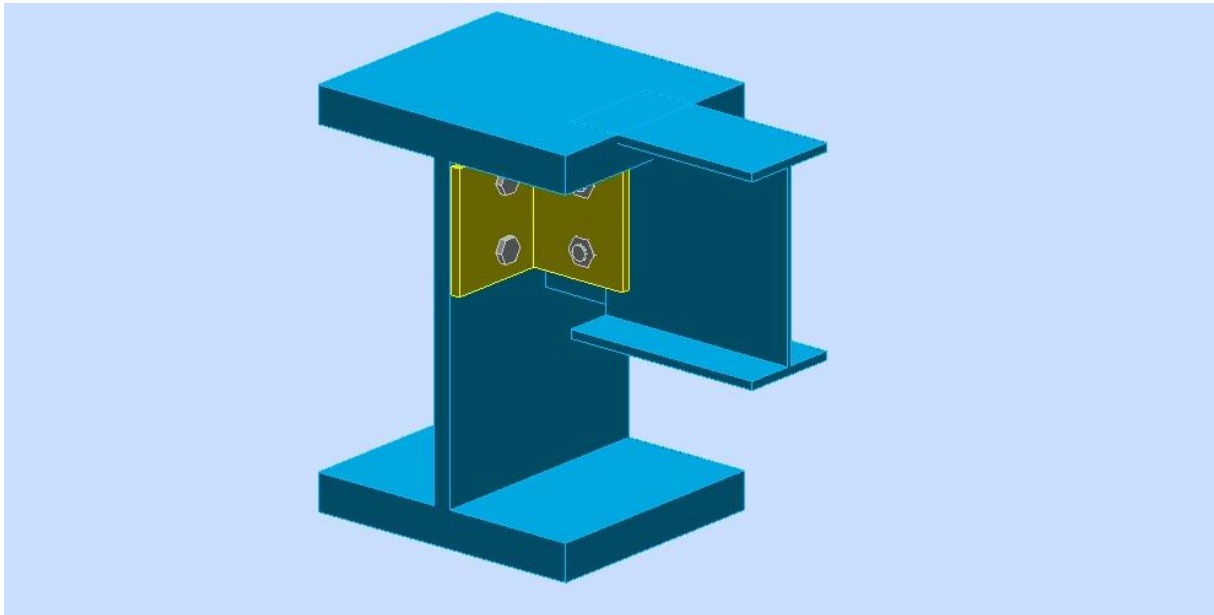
1 : Assemblage poutre-poutre (solive-poutre principale) .
